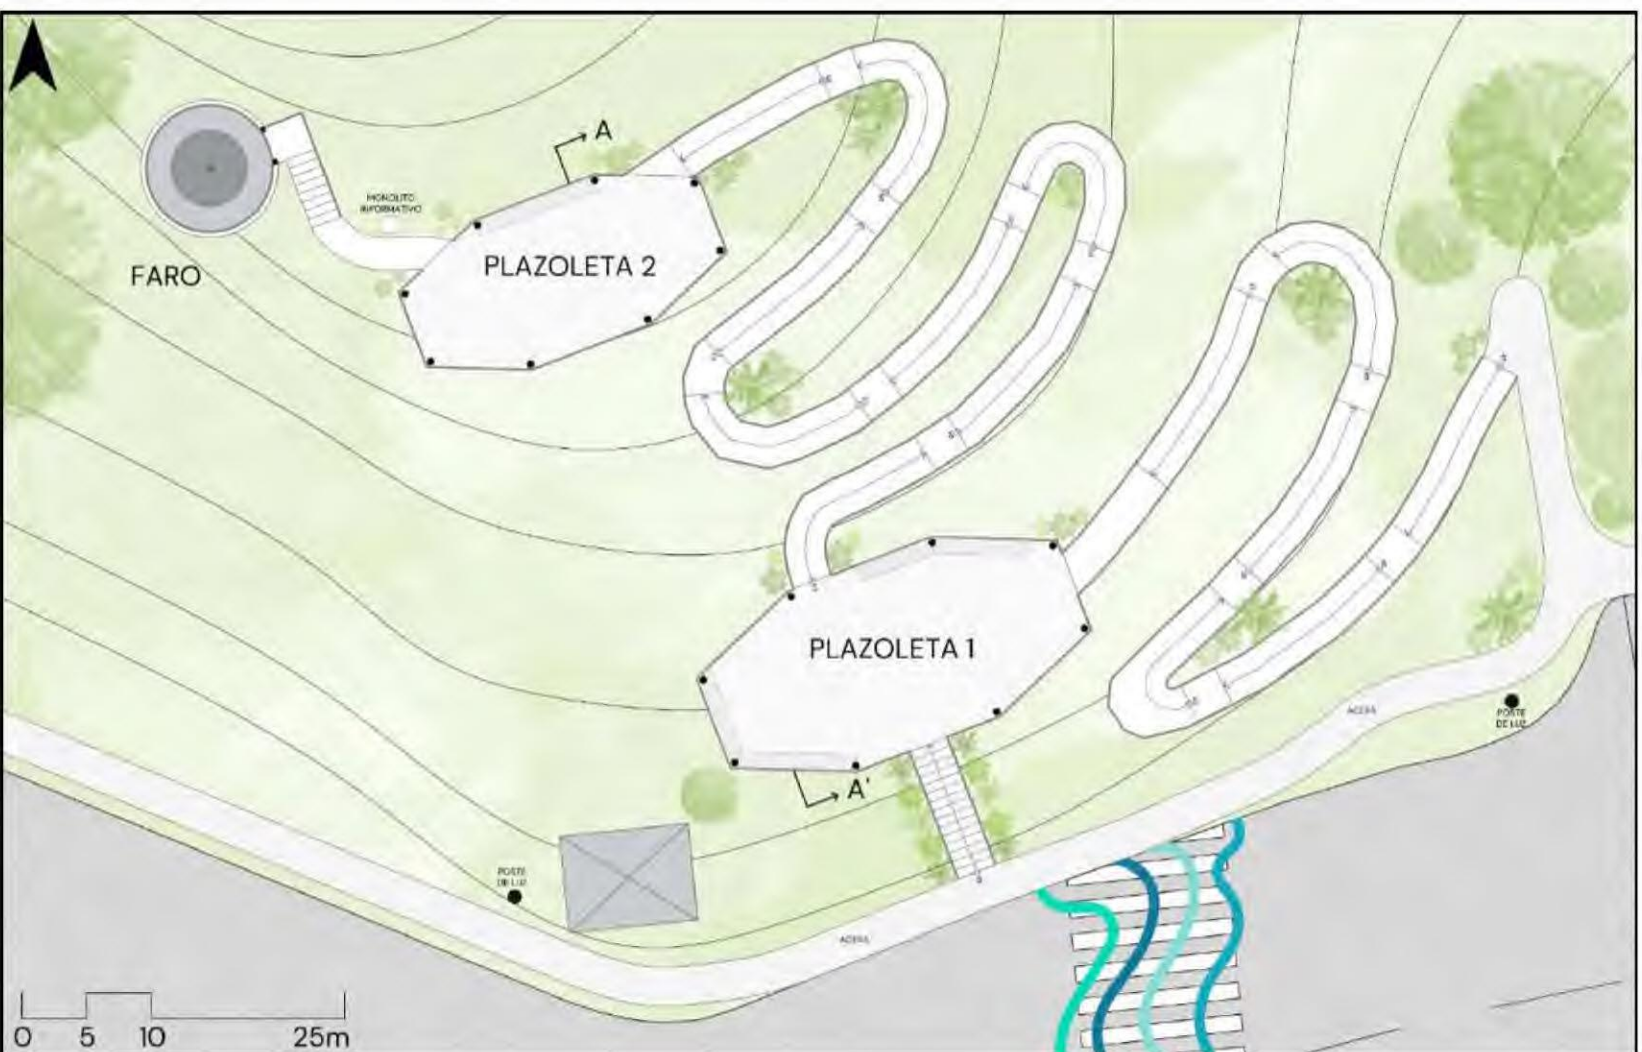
Ampliación de planta arquitectónica del mirador "El Faro": Plazoletas. Fuente: Autoría propia.
